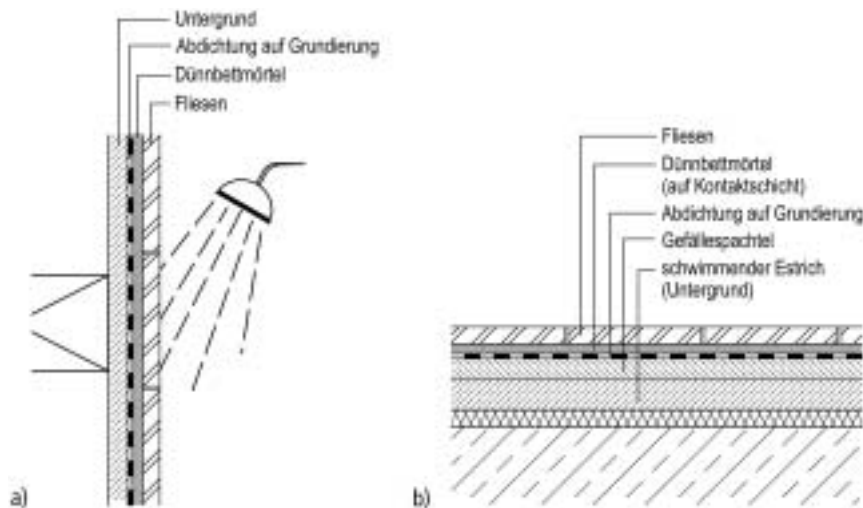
Aufbau einer Verbundabdichtung; a) Wandaufbau, b) Bodenaufbau
